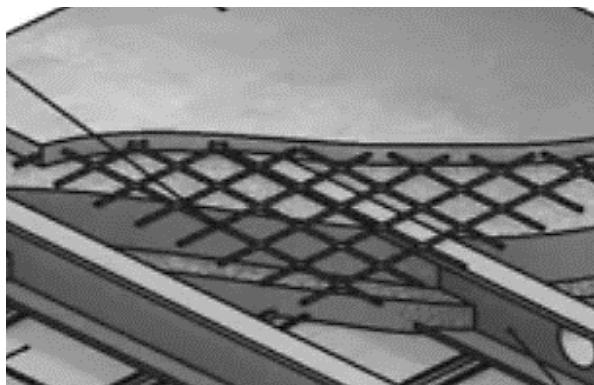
Перекрытие с жестким диском из конструкционного пенобетона
